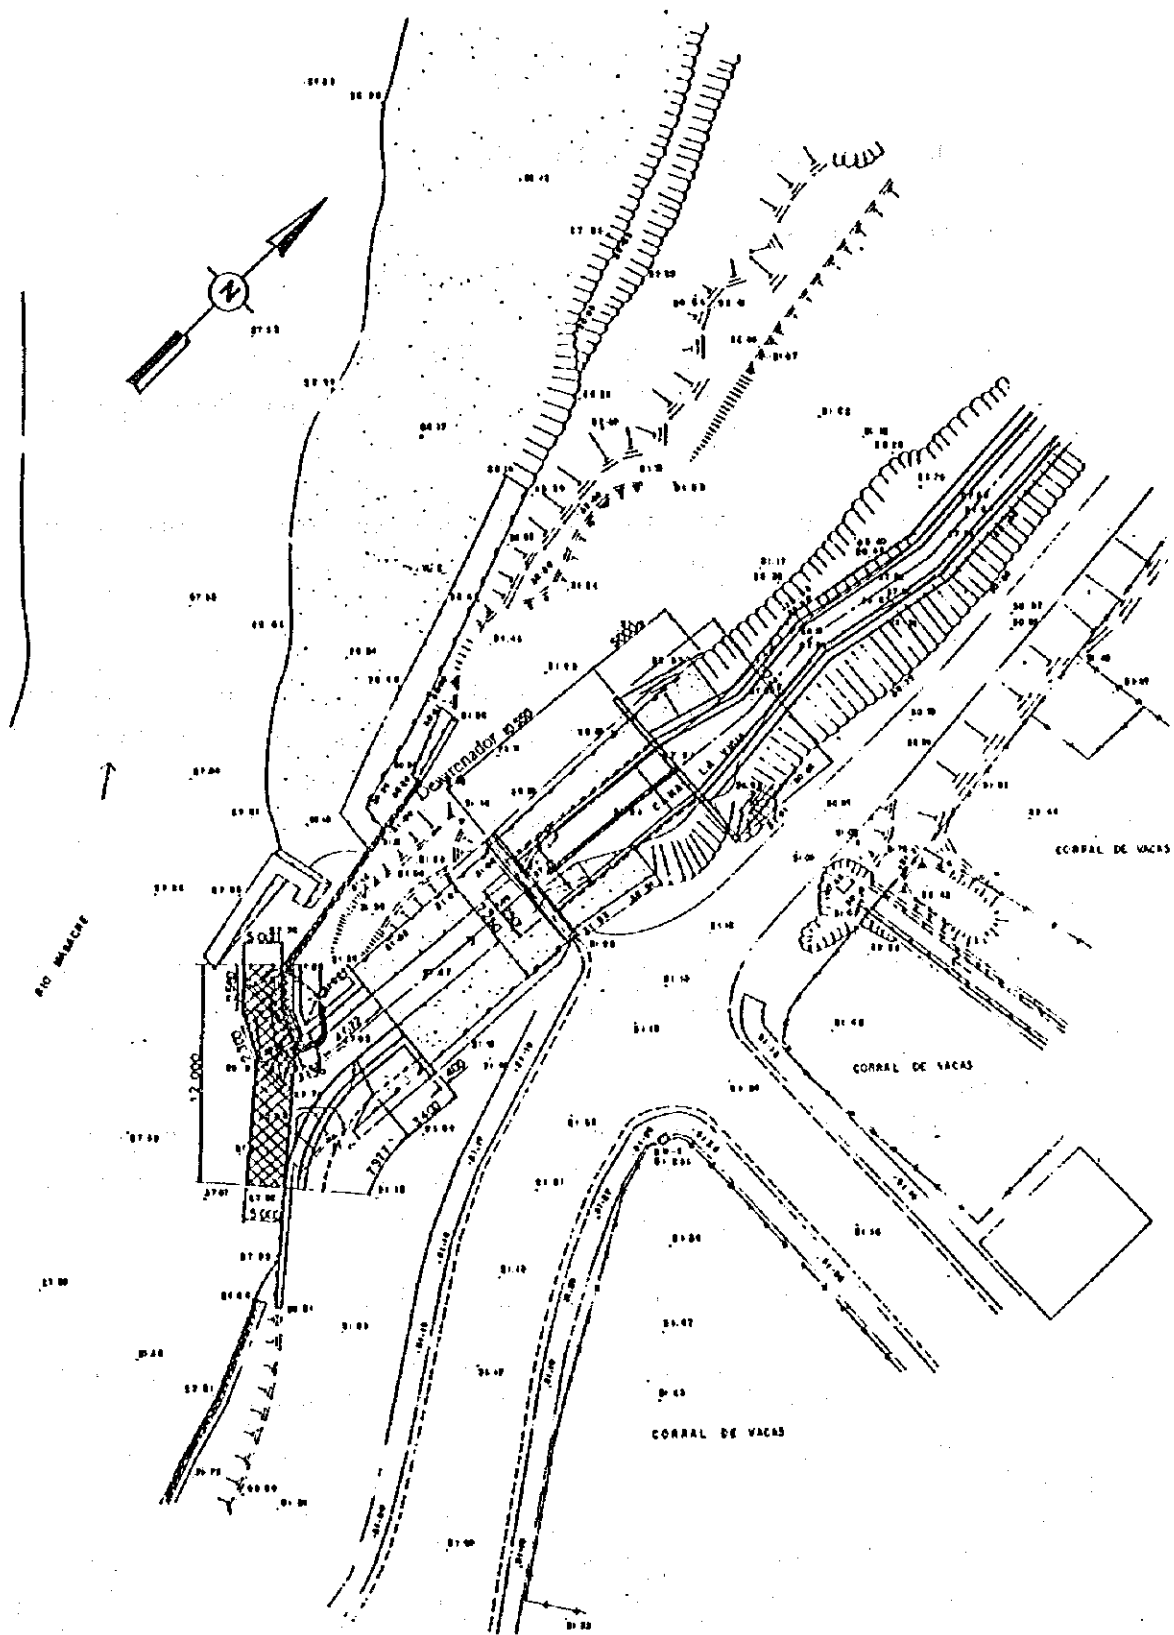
Plano general de la obra de toma , compuerta y desarenador
